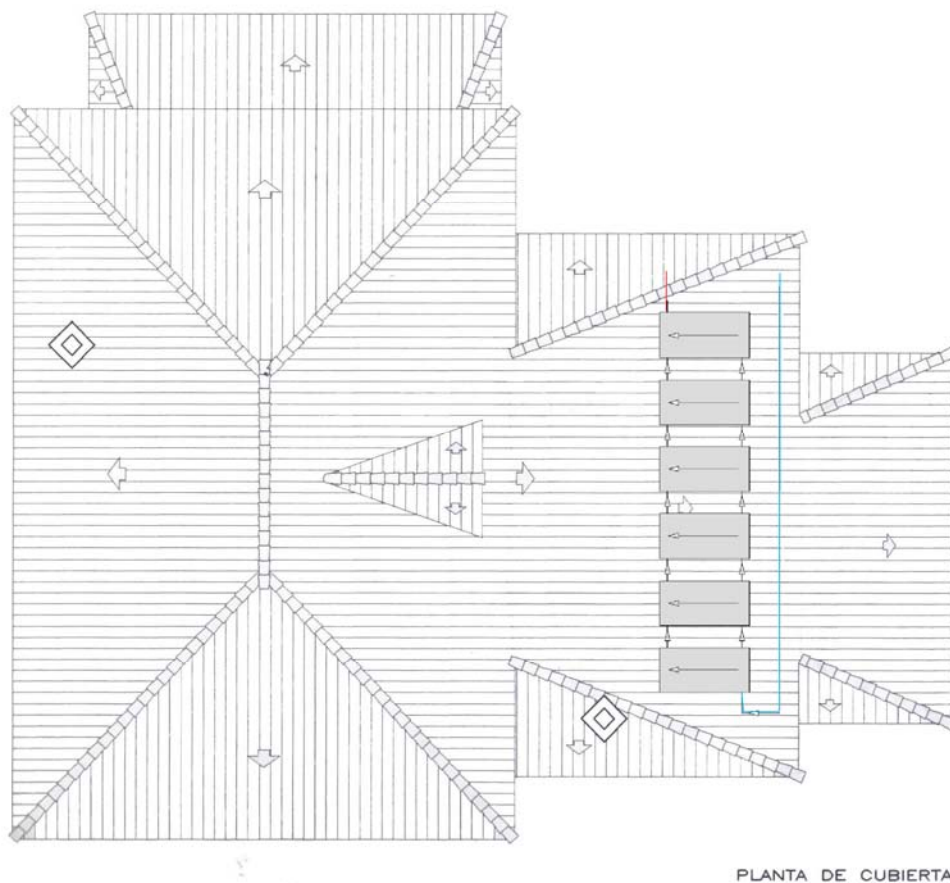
Planta de cubierta con los colectores dispuestos sobre ella.
